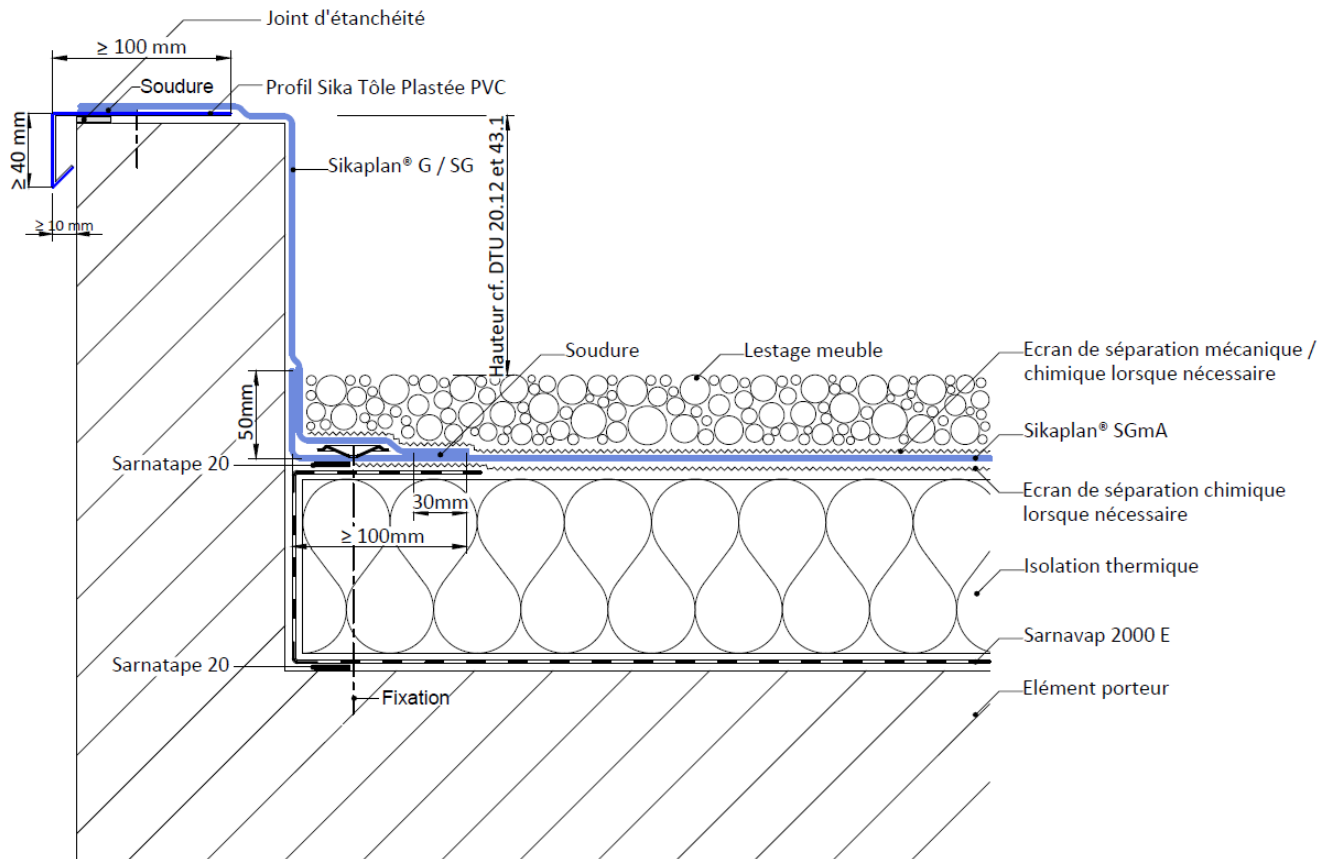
Relevé d'étanchéité avec profil de rive Sika Tôle Plastée PVC – Travaux neufs maçonnerie
